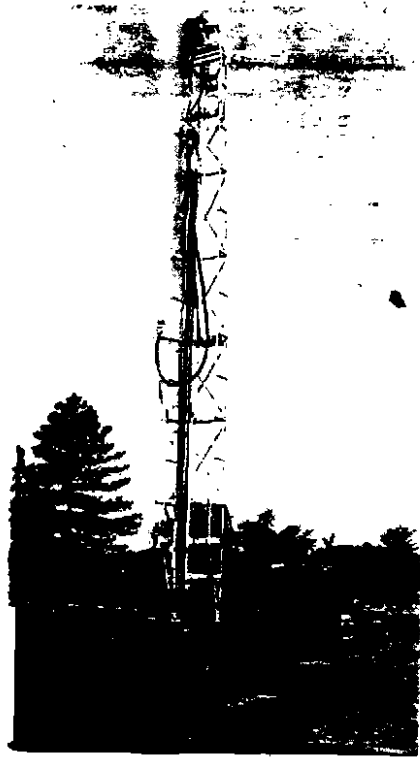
Máquina perforadora combinada de rotación y percusión.
